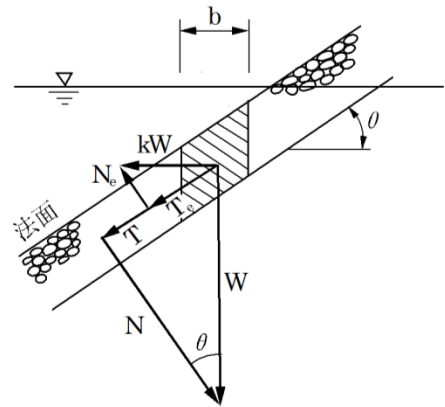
無限斜面の単位体積に作用する力 (満水地震時)
